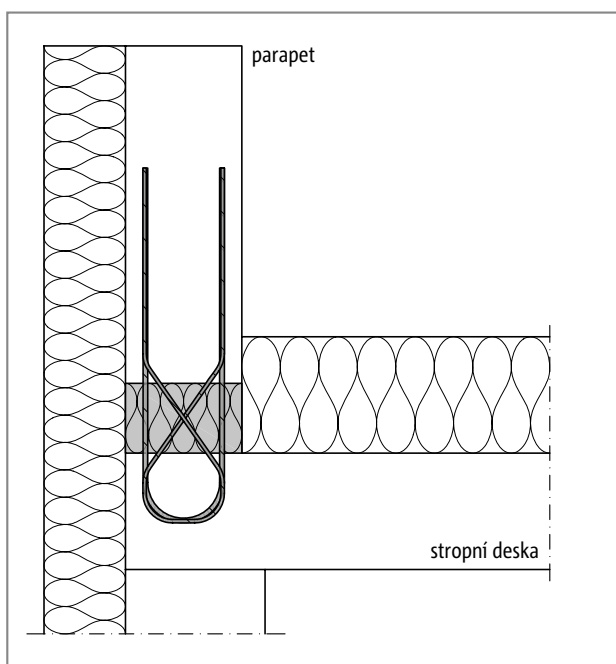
Schöck Isokorb® typ ABXT - vodorovné zabudování: Půdorys, před-sazení parapetu resp. atiky
